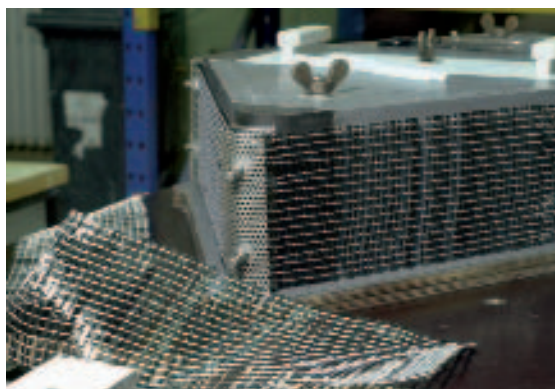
Монтажные узлы и текстильное армирование на пересечении.
